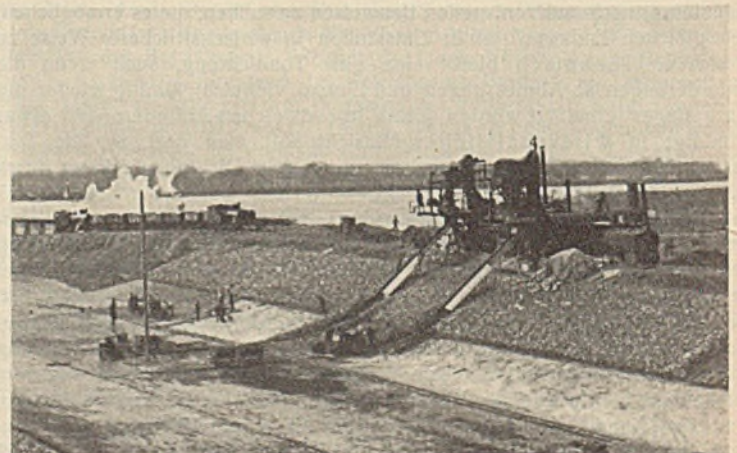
Einrichtung der Baustelle für den Einbau der Dichtung in Asphaltbauweise.
